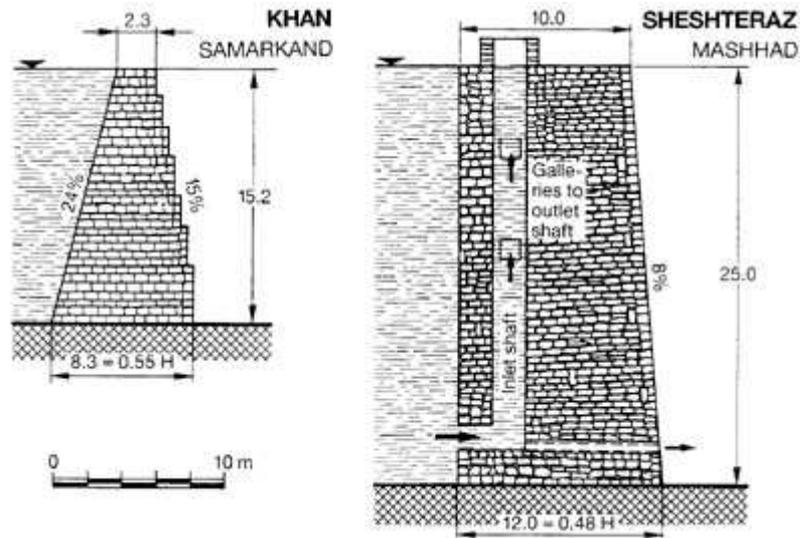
Coupes de barrages poids construits au X^{ème} siècle en Uzbekistan (d'après Schnitter)
